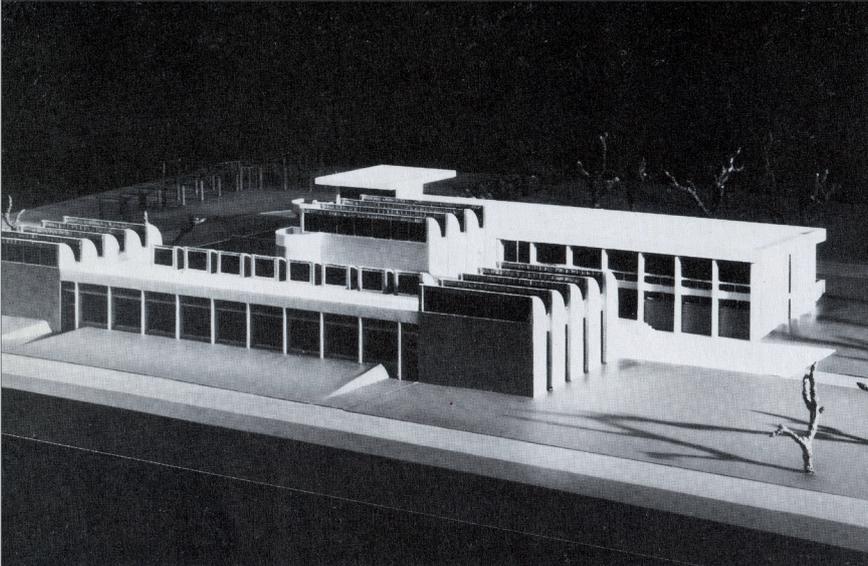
Architekturmodell, Planungsstand 1964 für den Standort Darmstadt. Die Ausstellungshalle im Vordergrund ist nach Norden geöffnet.
